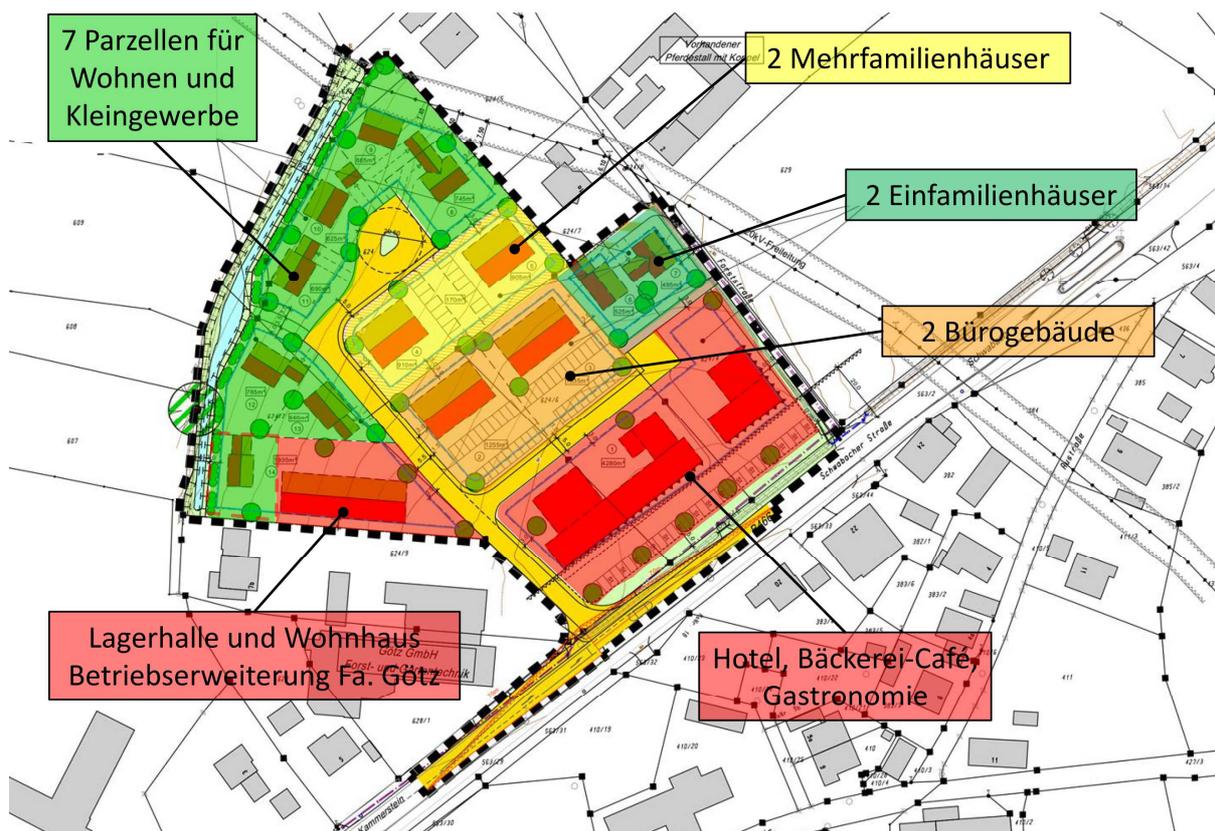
Geplante Nutzung der Bauflächen im Mischgebiet „Im Hausacker“
